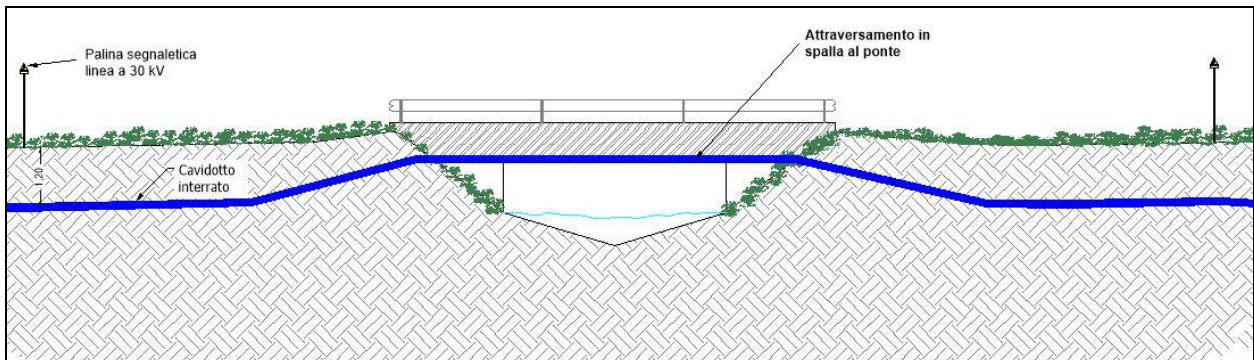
Tecnica attraversamento in spalla al ponte
